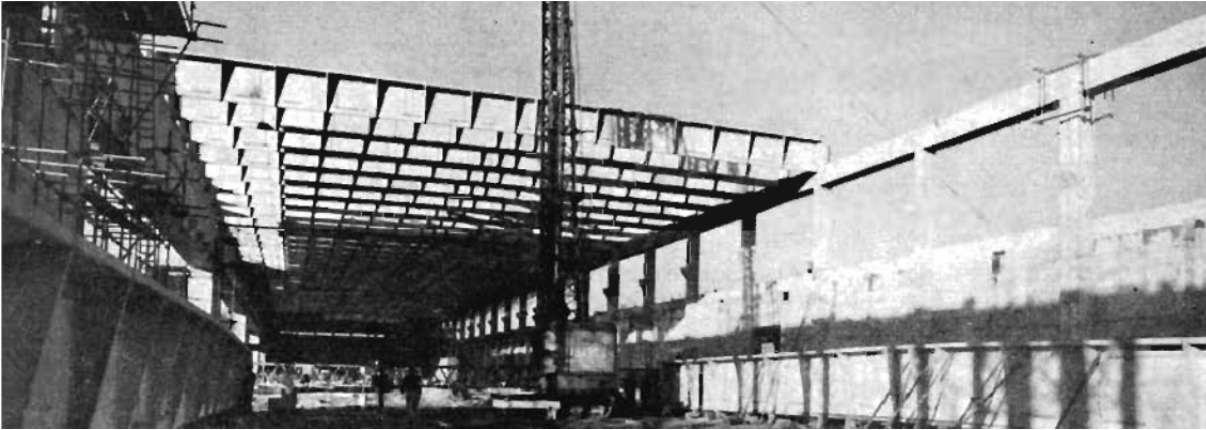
Vigas de cobertura do hangar do aeroporto de Londres com 33,5 m de vão e 1,83 m de altura
